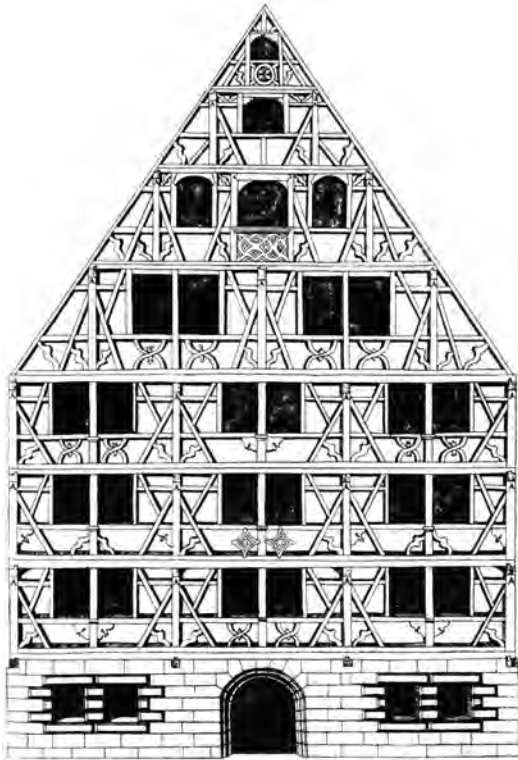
Bauentwurf eines vierstöckigen Fachwerkhauses (Wilhelm 1668 Bd. 2, Tafel 1)
